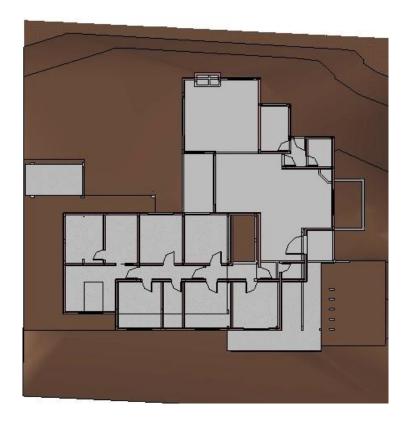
Pavimento térreo a compatibilizar Fonte: Autoria Própria – Extraído do software Revit (2017)
